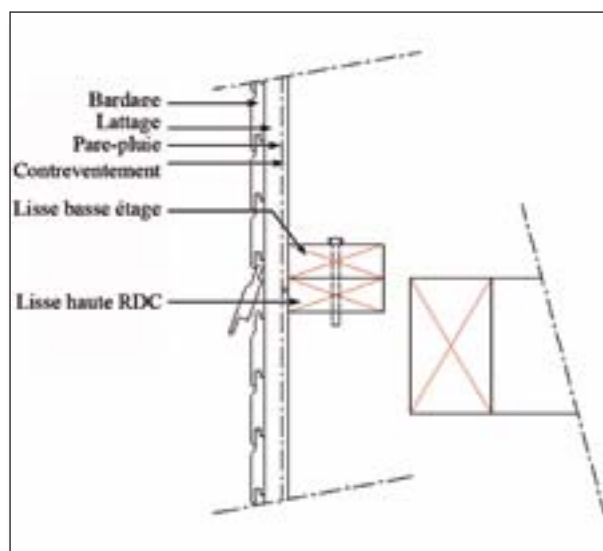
Coupe d'assemblage d'un solivage apparent (vue de profil)
